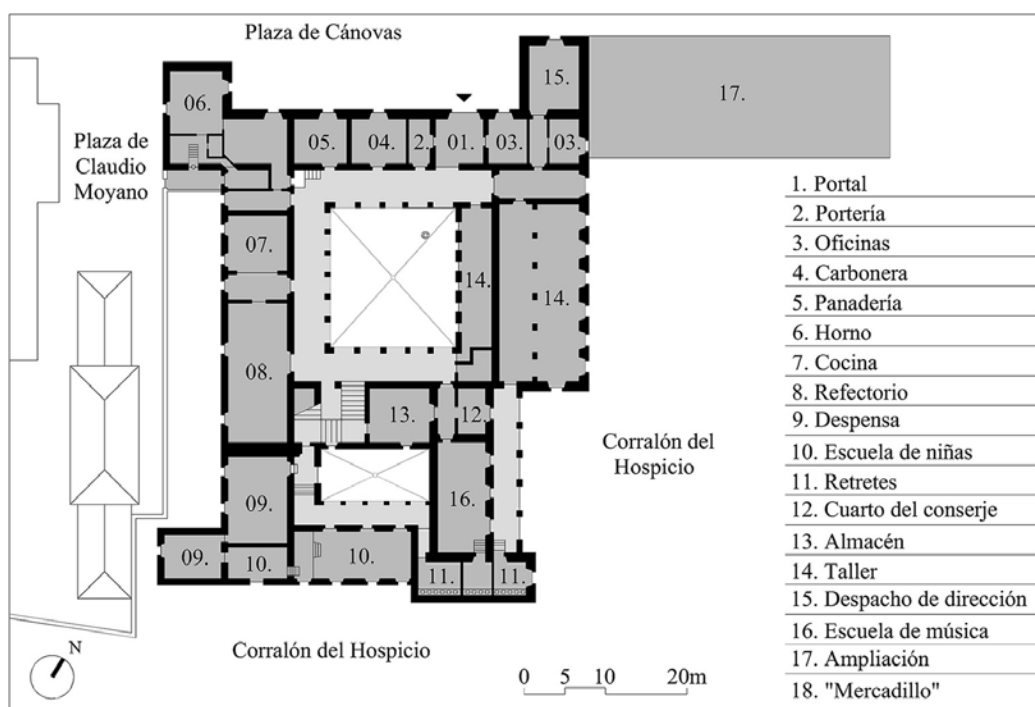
PLANTA BAJA DEL HOSPICIO PROVINCIAL.
